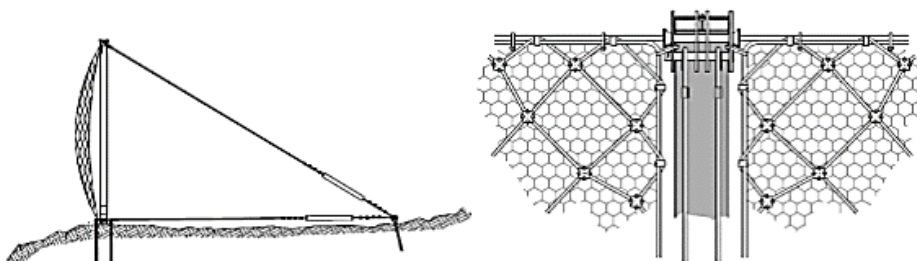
Corte e alçado tipo de uma barreira dinâmica (adaptado de Rodrigues, 2013)
